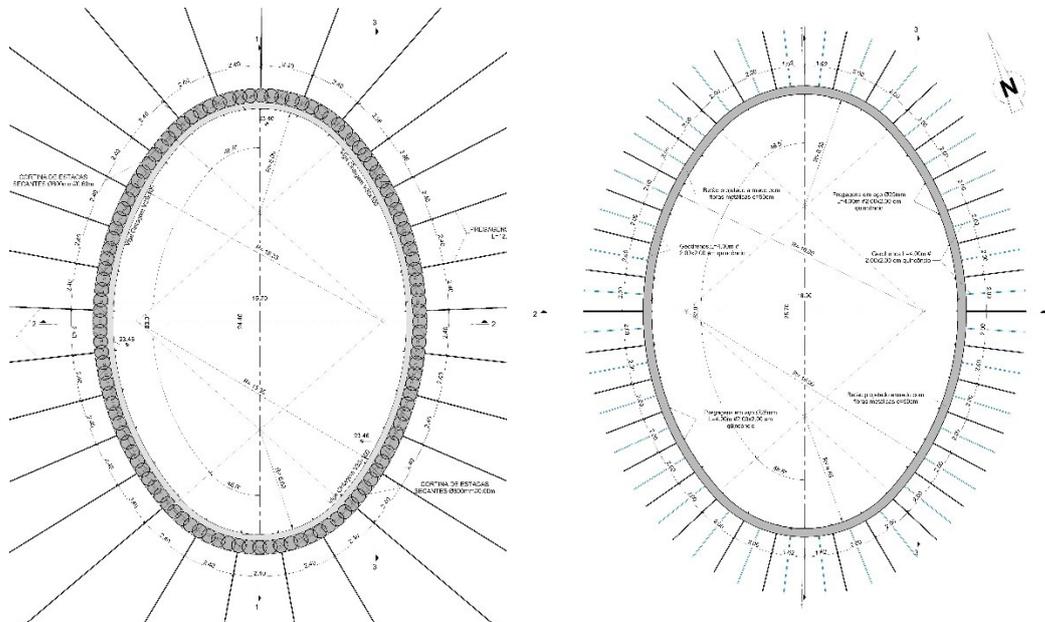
Plantas da solução de contenção provisória do poço PV217 (cortina de estacas, à esquerda; betão projetado armado com fibras metálicas, à direita)
